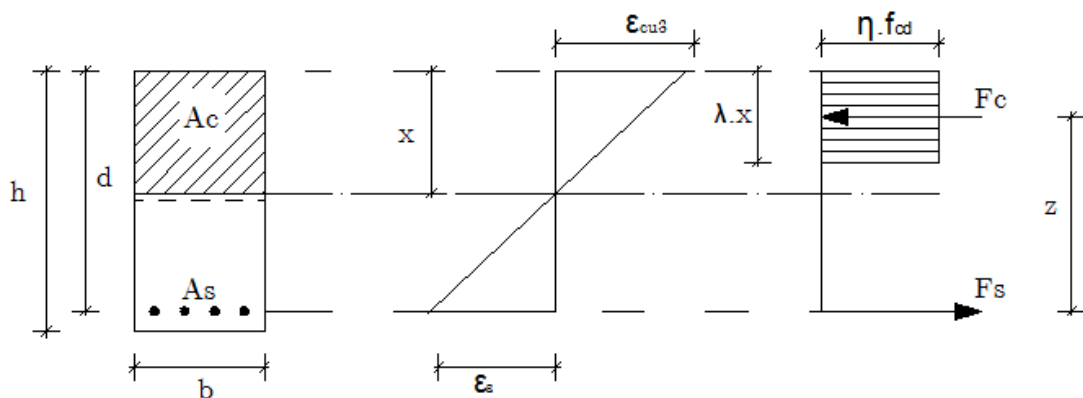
Distribuição retangular de tensões (adaptado da NP EN 1992-1-1 2010-3.1.7(3))
